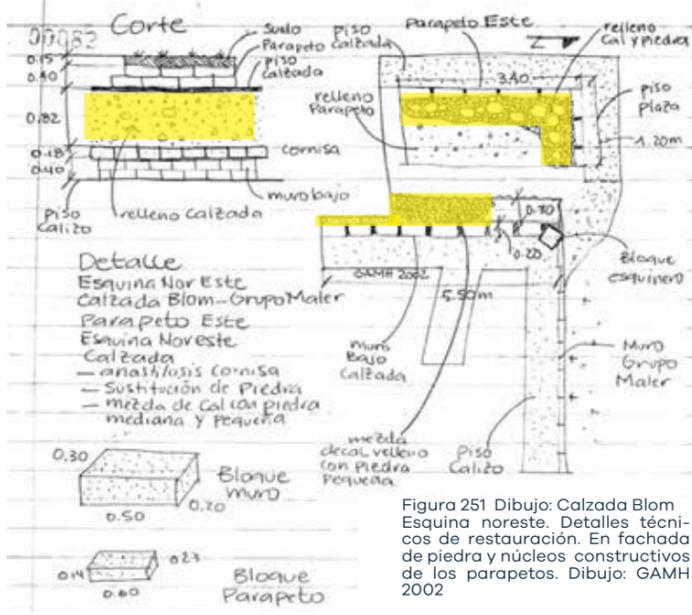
Dibujo: Calzada Blom. Esquina noreste. Detalles técnicos de restauración. En fachada de piedra y núcleos constructivos de los parapetos. Dibujo: GAMH 2002
